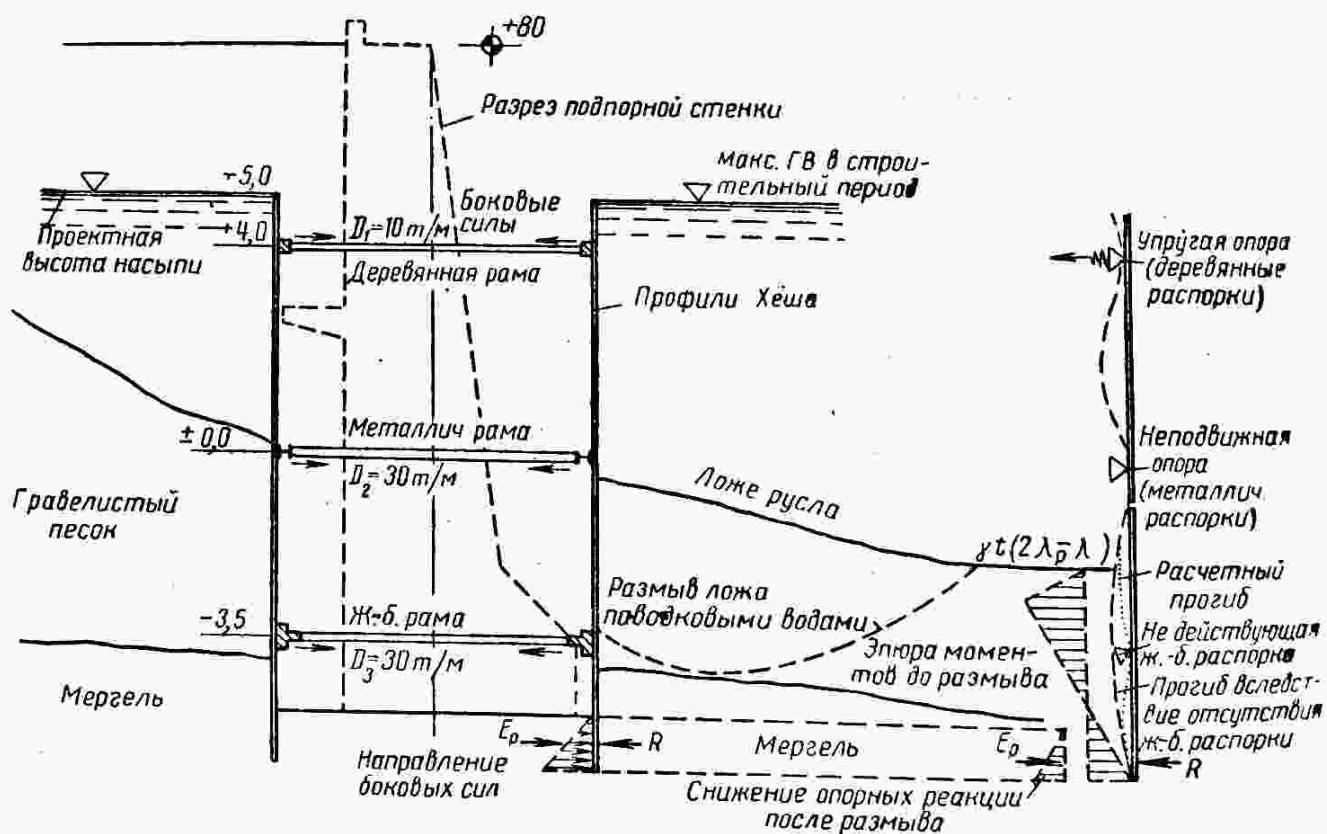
Схема подпорной береговой стенки углепогрузочной набережной в Обуде (Будапешт)
